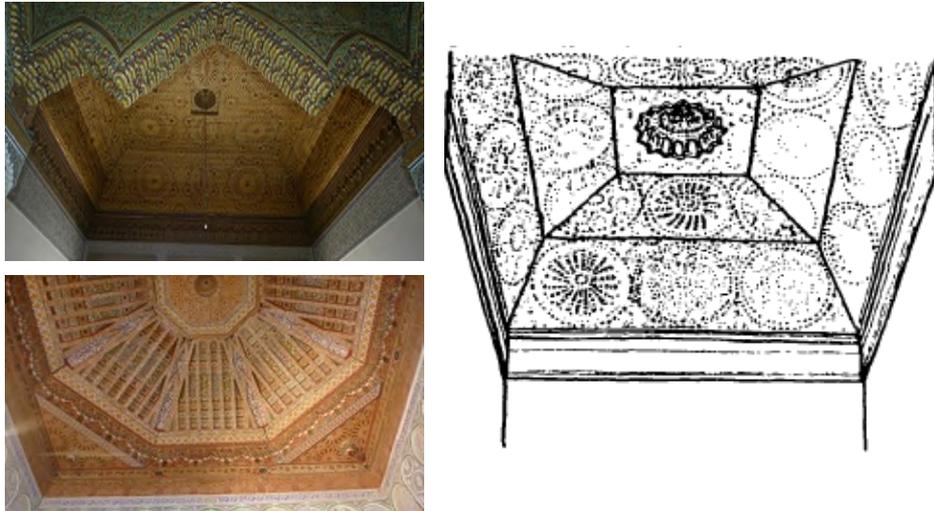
Plafonds rapportés –Jefna- à plan quadrangulaire et à plan polygonal.
